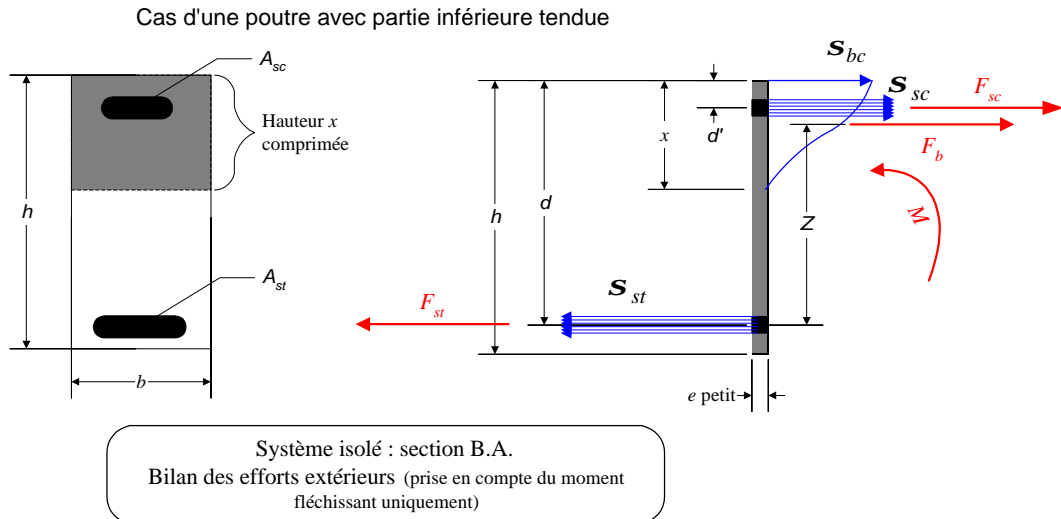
Bilan statique et état des contraintes d'une section de poutre BA
